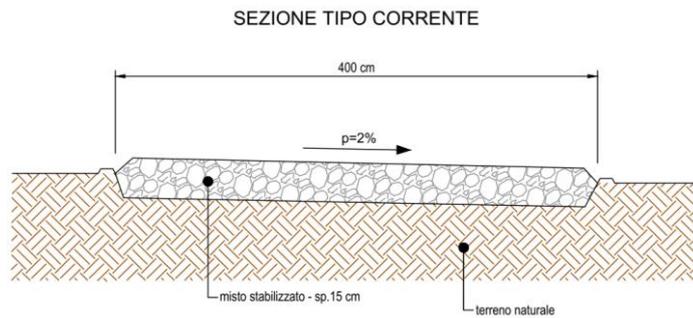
Sezione tipo delle piste interne per manutenzione (estratto di PRO\_TAV\_15a)
